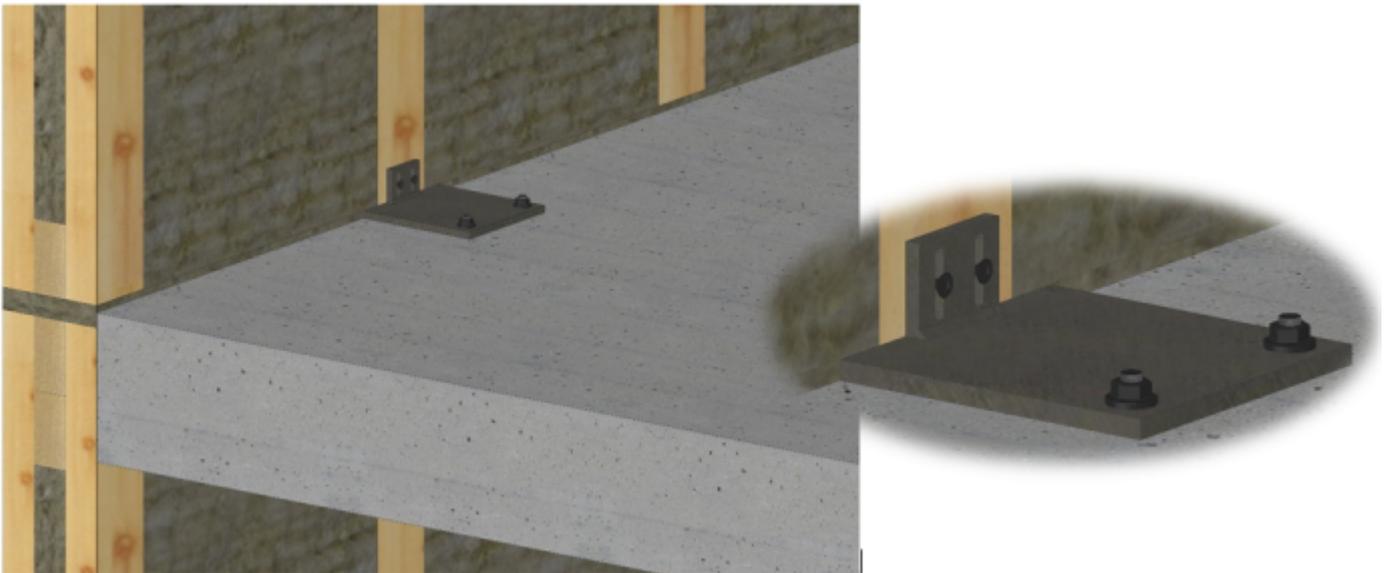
Fixation du panneau supérieur sur le plat de liaison
